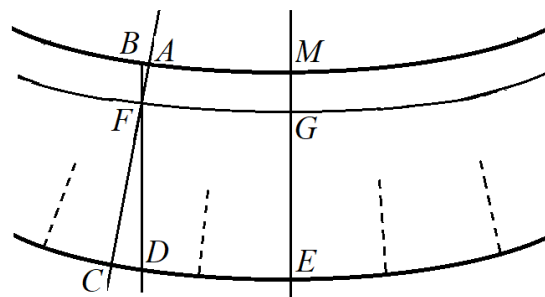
Появление поперечных трещин в растянутой зоне бетона
